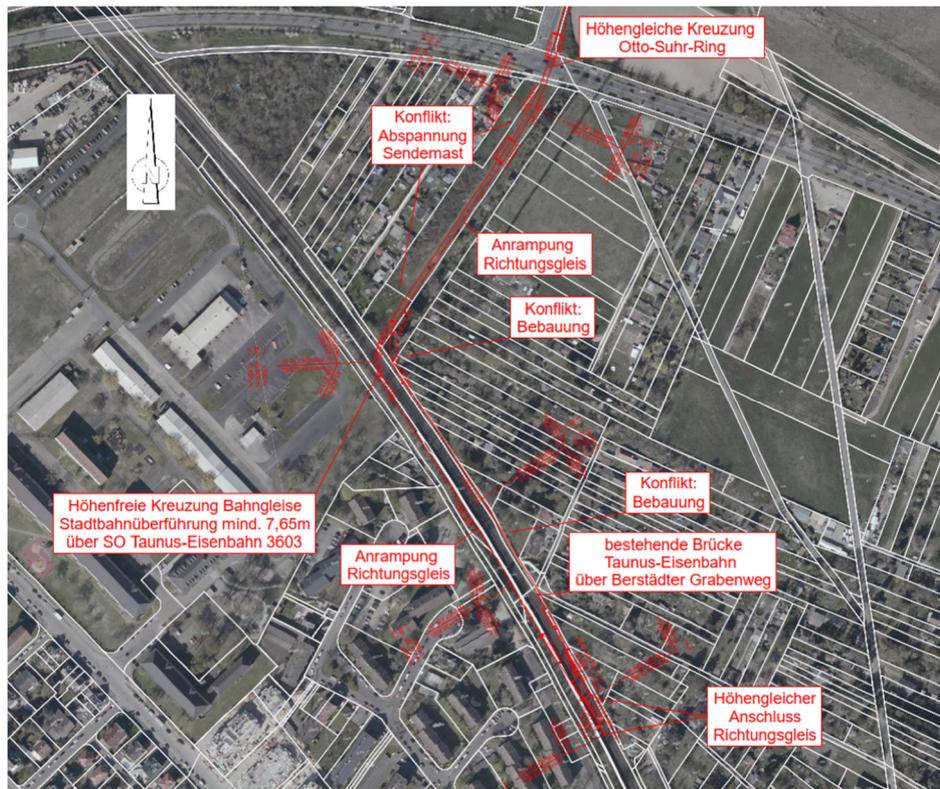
Lageplanausschnitt – Anschluss an Taunus-Eisenbahn
